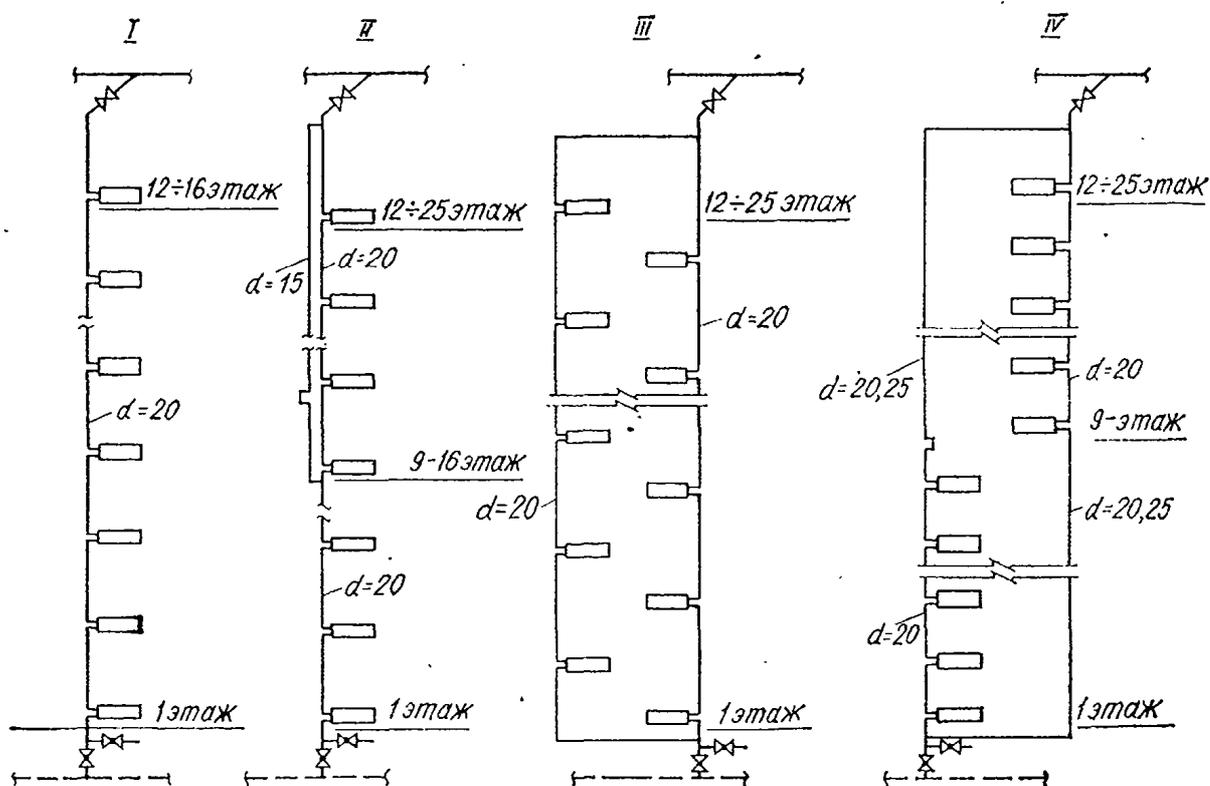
Конструкция стояков однострубной вертикальной системы отопления многоэтажных зданий с верхней прокладкой подающего трубопровода. I – унифицированный стояк; II – стояк с перемычкой; III – спаренный стояк с приборными узлами через этаж; IV – спаренный стояк с частично нагруженными ветвями
